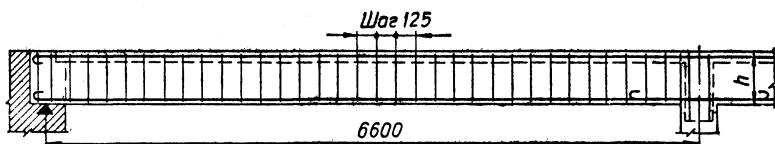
Армирование балки сварными каркасами.
